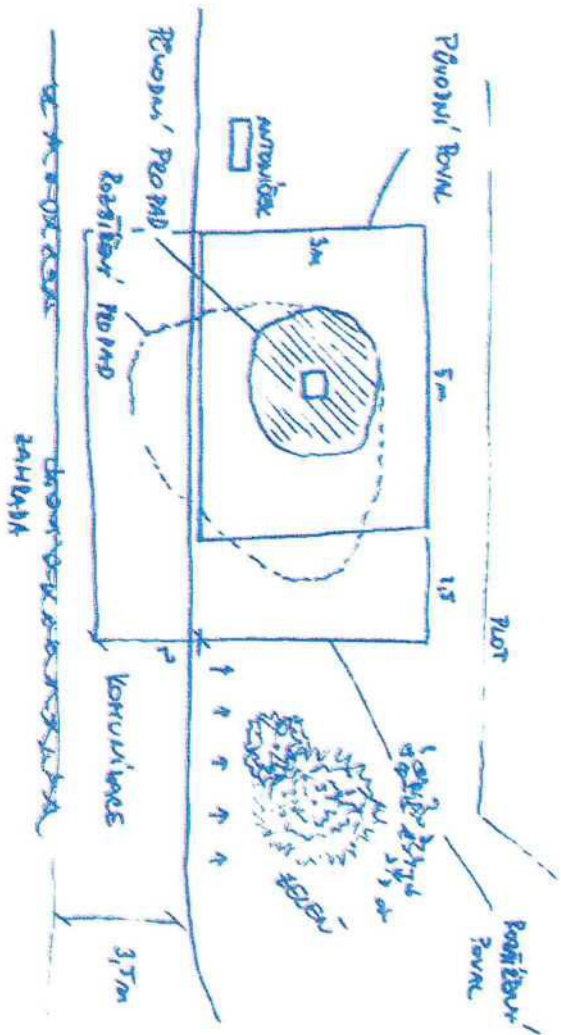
Detail zvětšení propadu – pohled západní stěna
